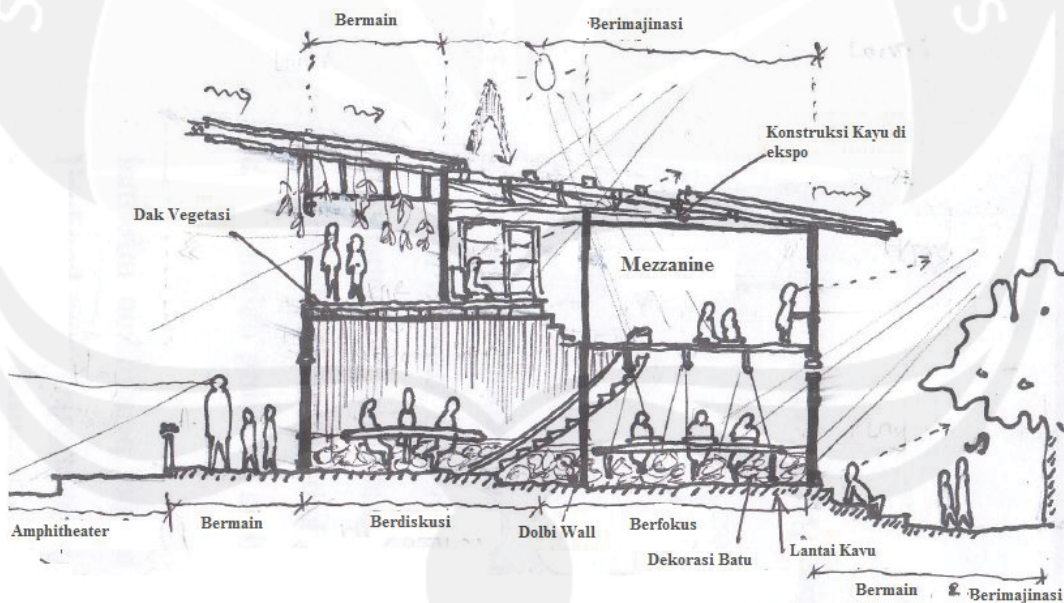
Konsep Desain Ruang Serba Guna Lantai 2
